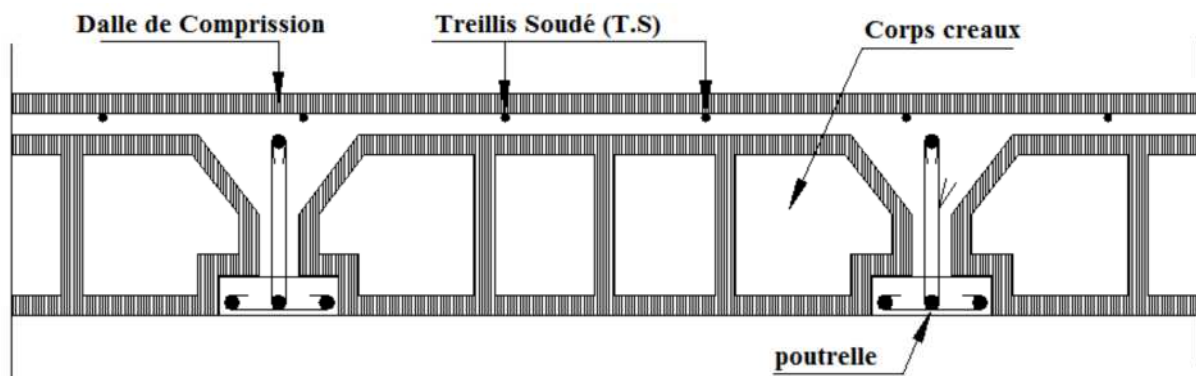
coupe transversale dans un plancher en corps creux.
